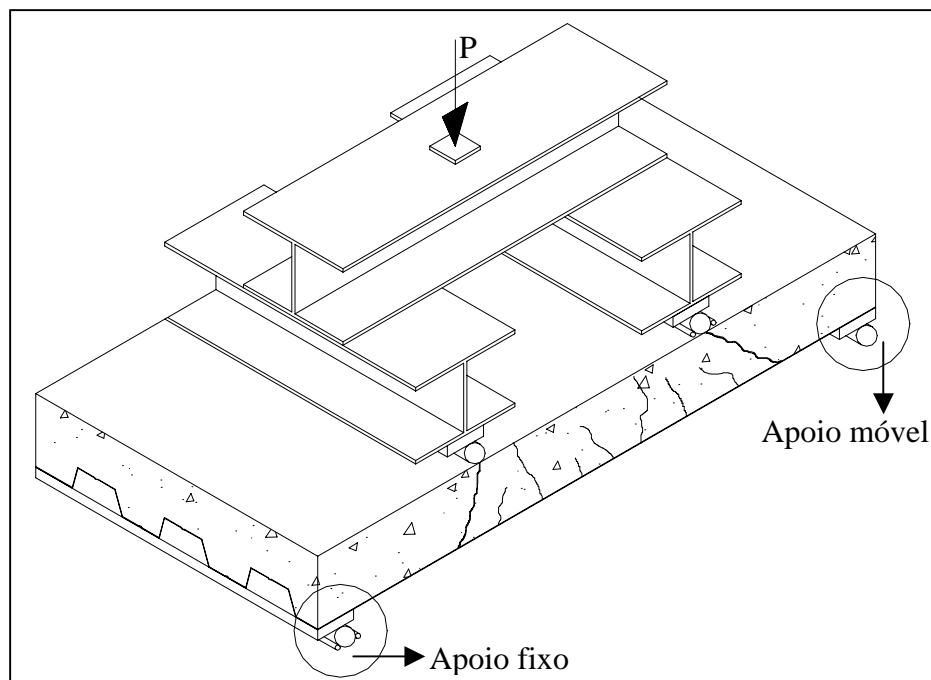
Fissuras observadas nos protótipos da série A à D
